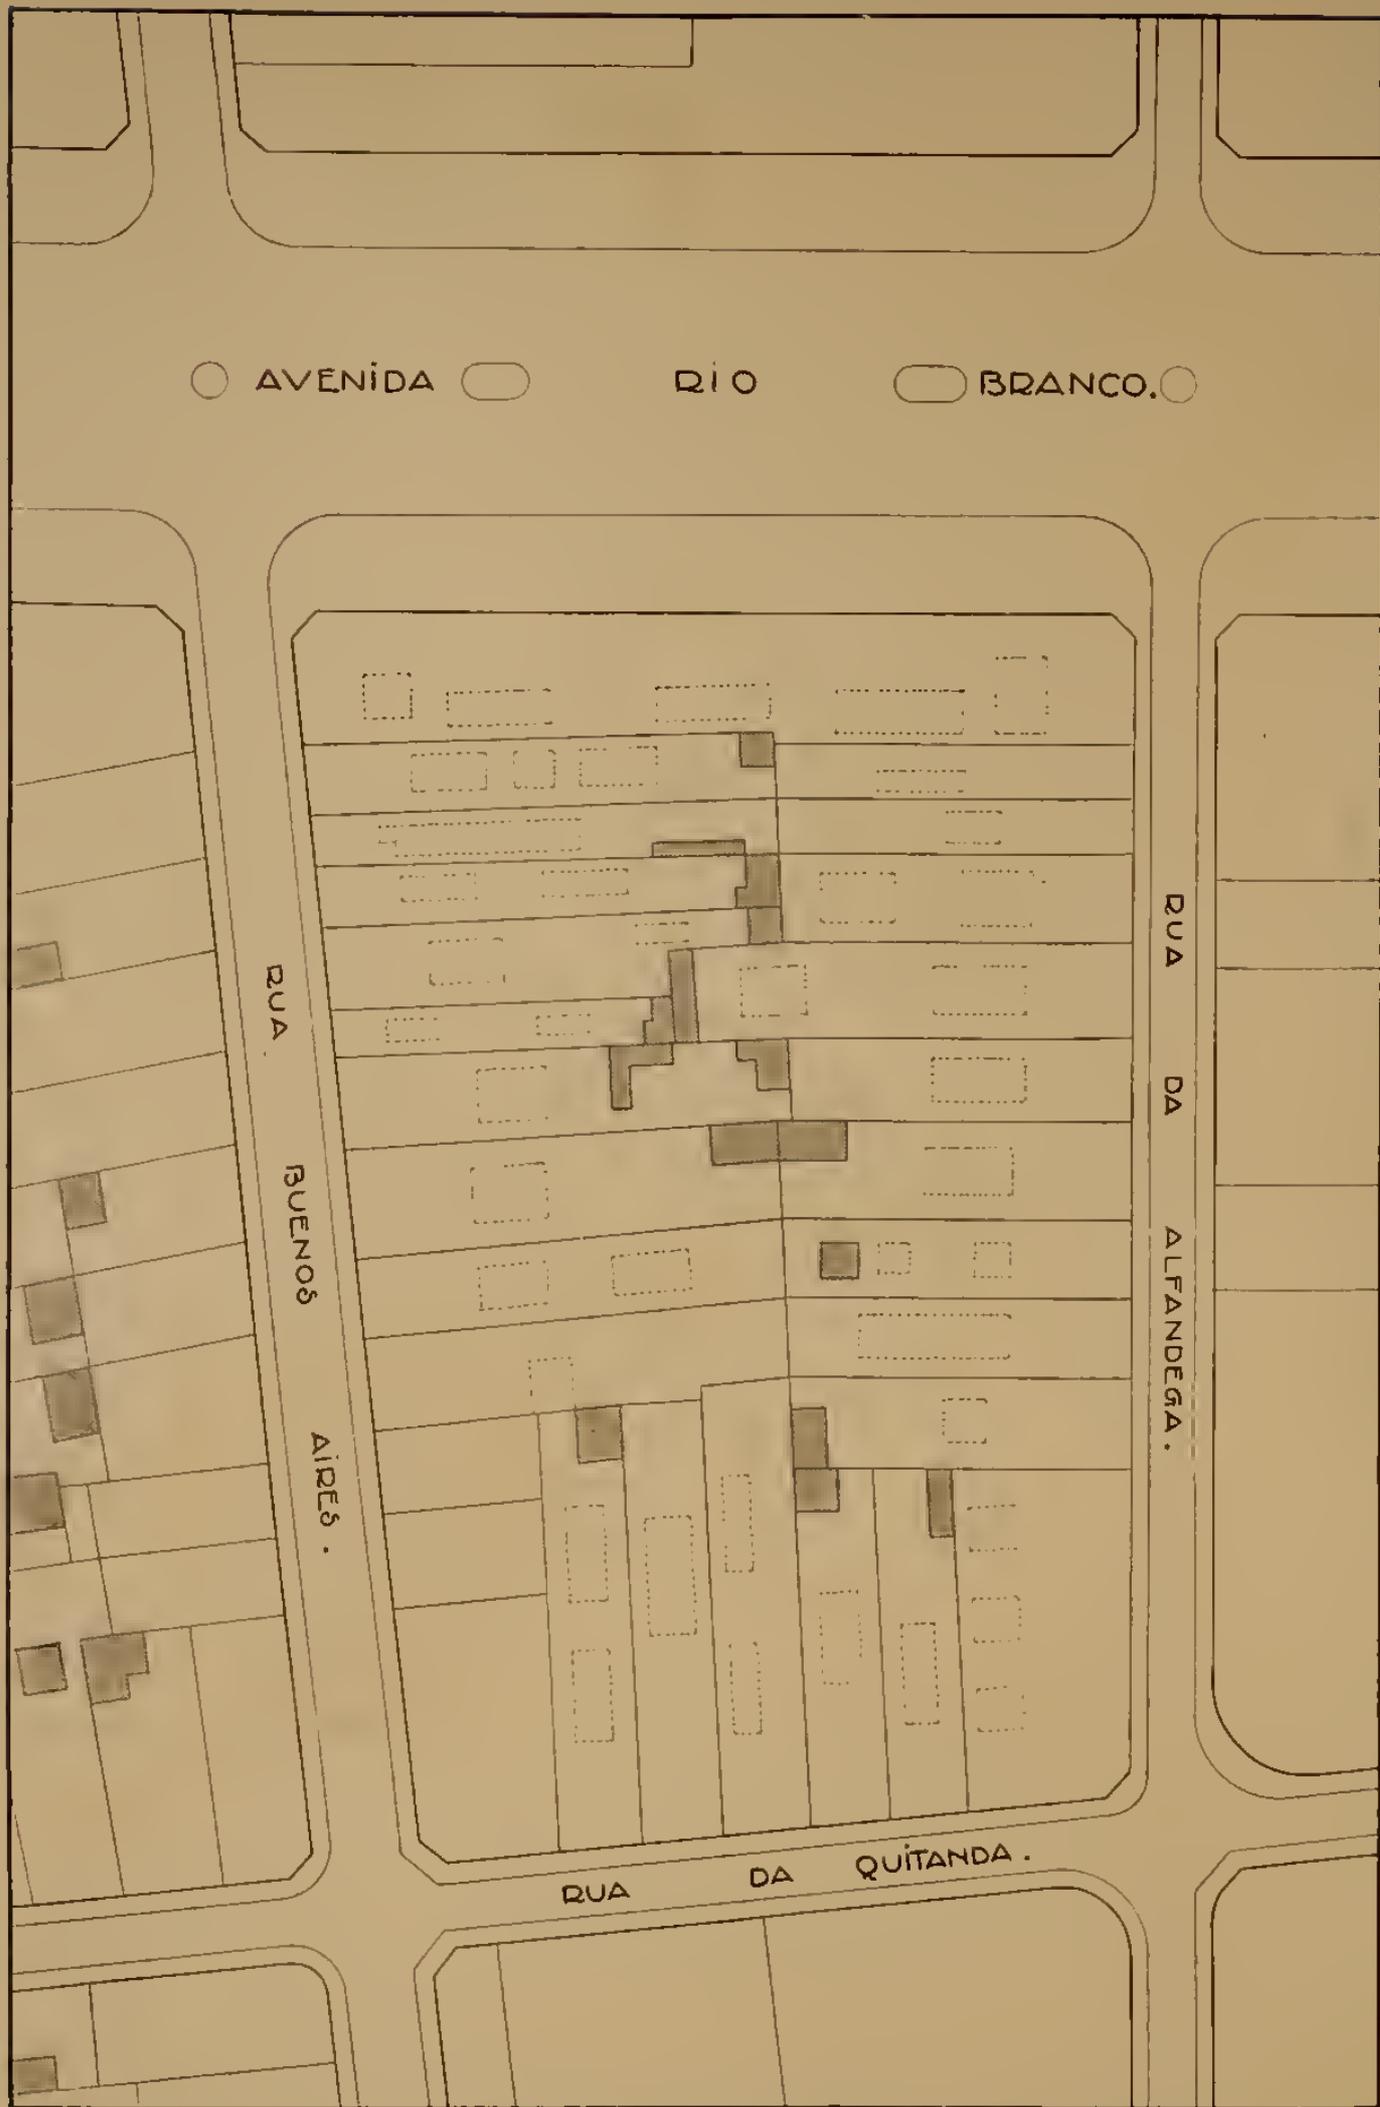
Planta do estado actual de um quarteirão do centro bancario.
